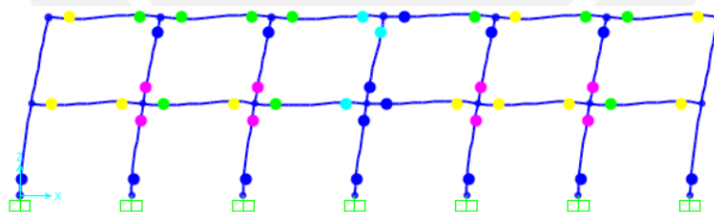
Rótulas plásticas y mecanismo de colapso para módulo de 2 pisos sin interacción tabique - pórtico.
